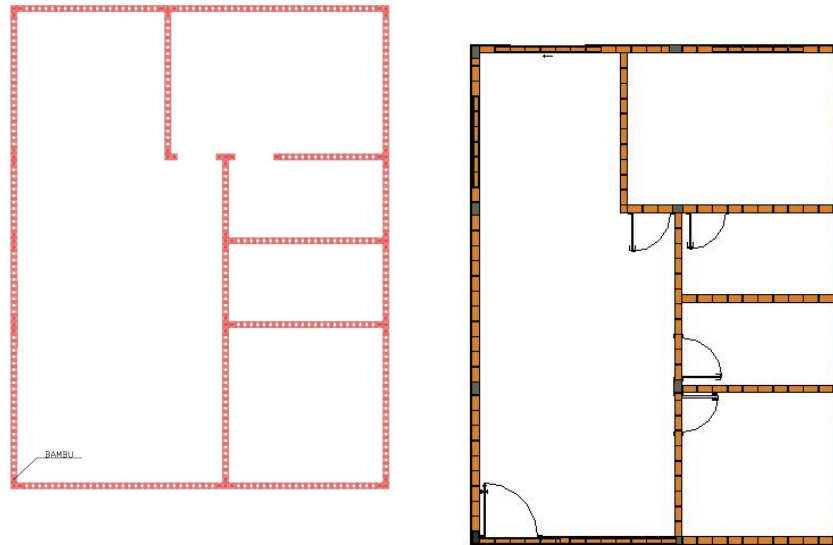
Imagens do projeto da primeira fiada de tijolos ecológicos com a estrutura de bambu e dos blocos cerâmicos com os pilares de concreto armado. (Fonte: Próprio autor).
